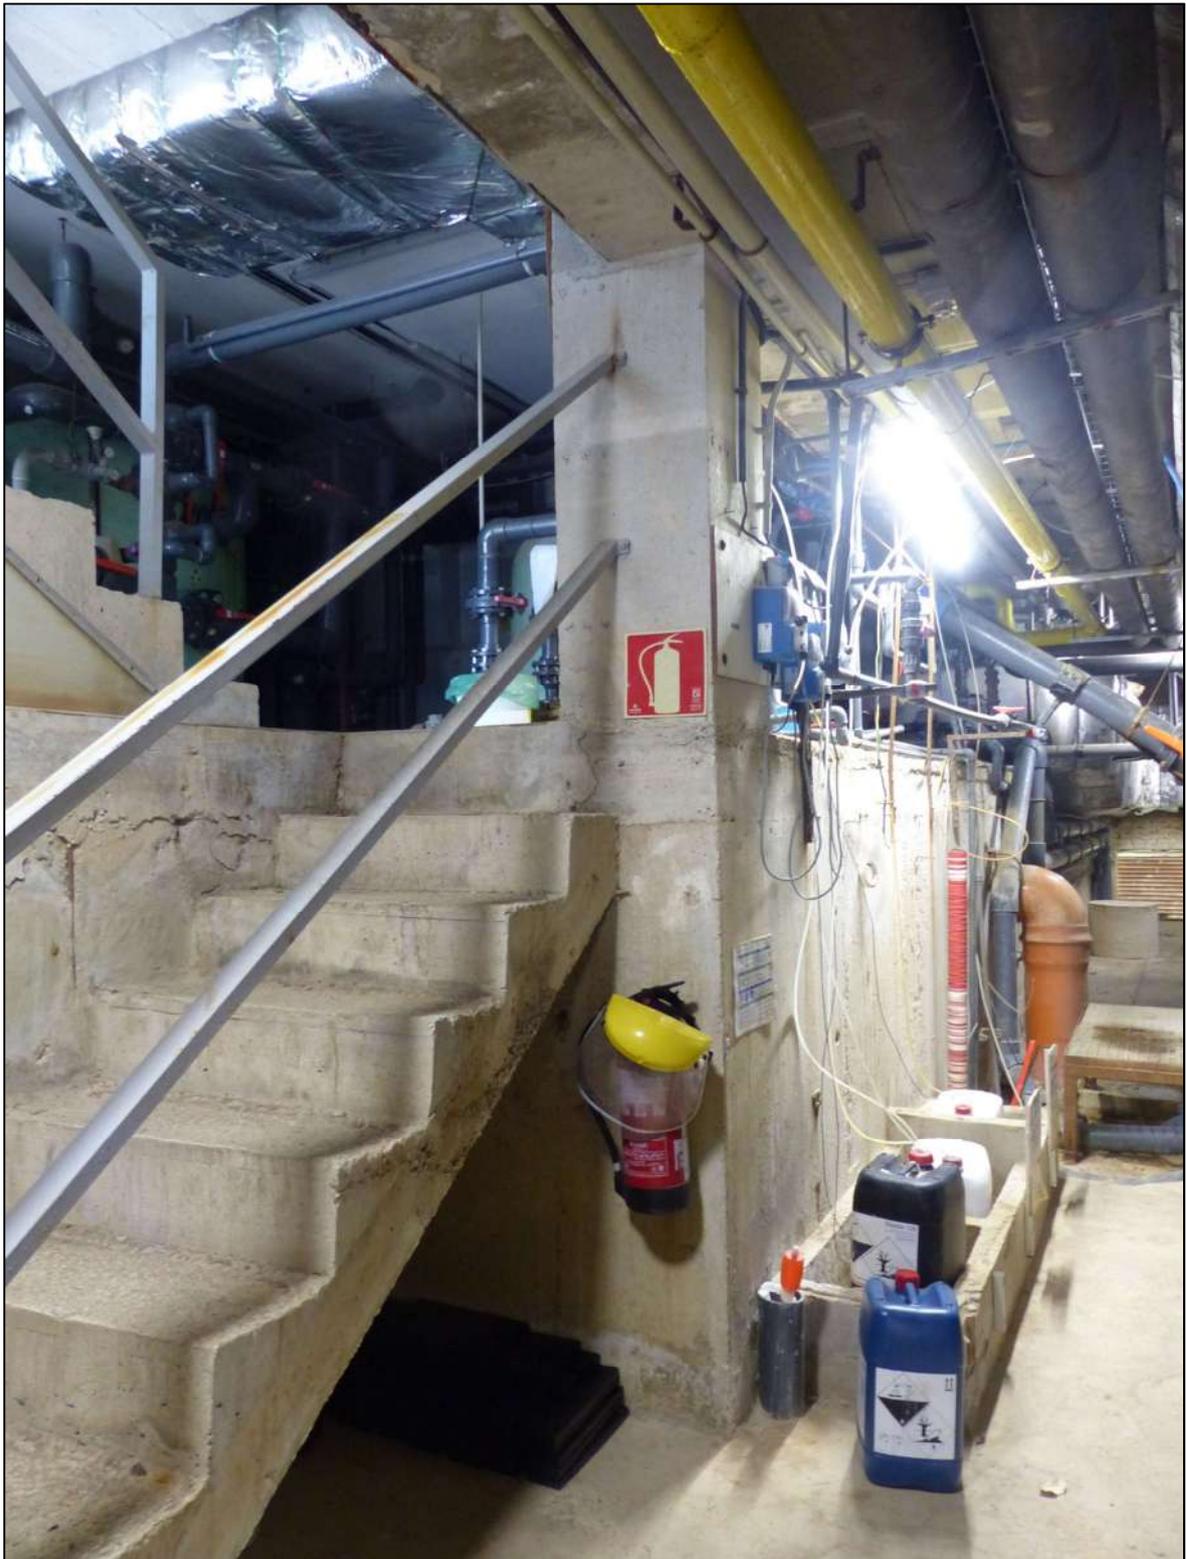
Imágenes de otra de las zonas de galerías bajo la piscina cubierta municipal. Esta zona cuenta con dos niveles y una puerta de acceso y salida hacia la zona de las pistas de atletismo.
